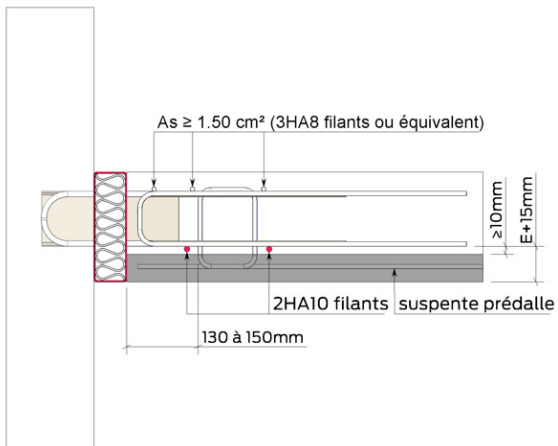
Exemple de détail de ferrailage de prédalle avec suspente servant de chaînage de plancher (2)
